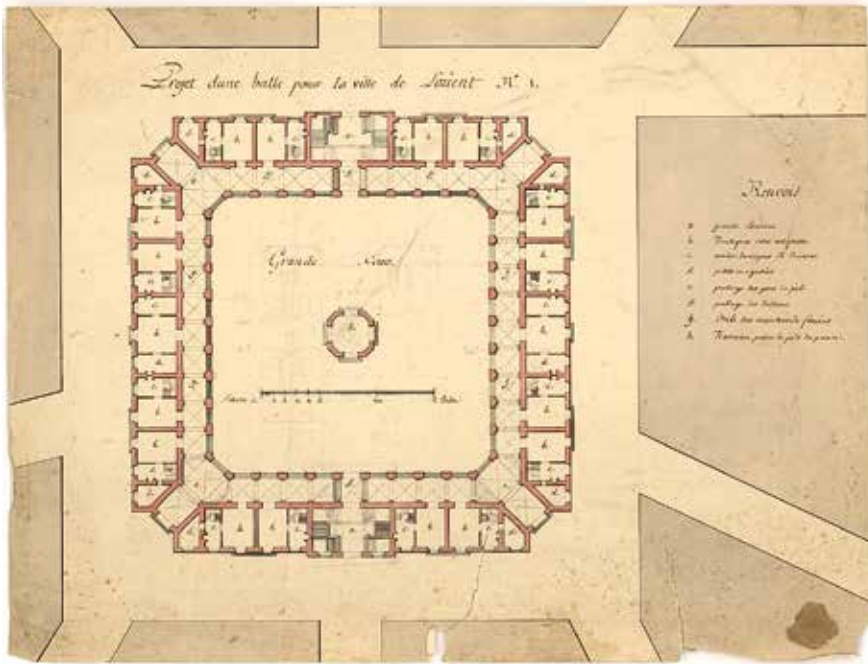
Plan de rez-de-chaussée des halles, non daté, non signé (1782) (Arch. mun. Lorient, 2 Fi 481)
